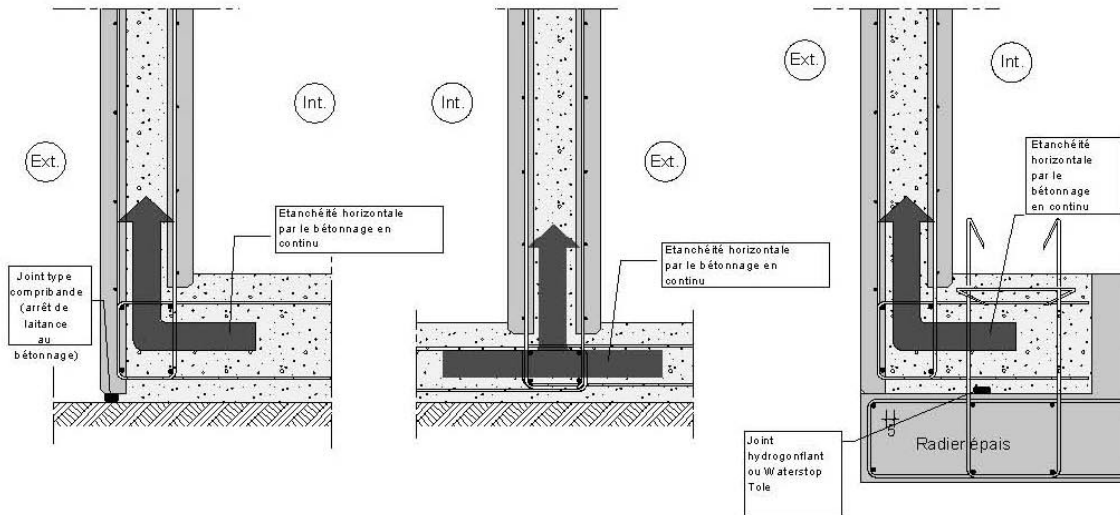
Etanchéité d'un mur d'épaisseur 20 cm
